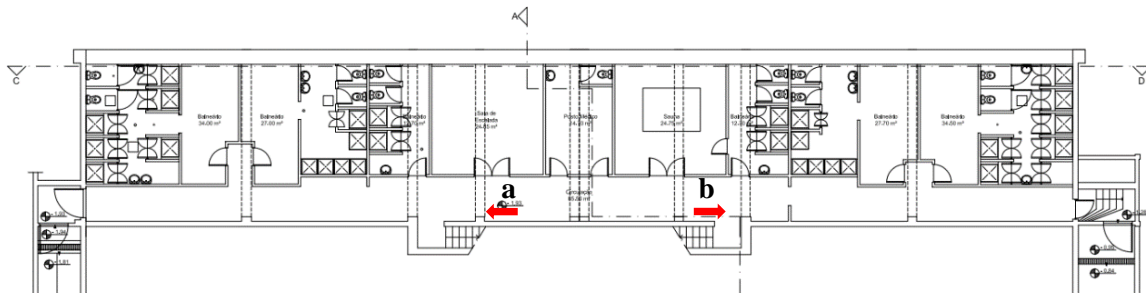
Planta da zona restrita do Pavilhão n°1 da UBI
